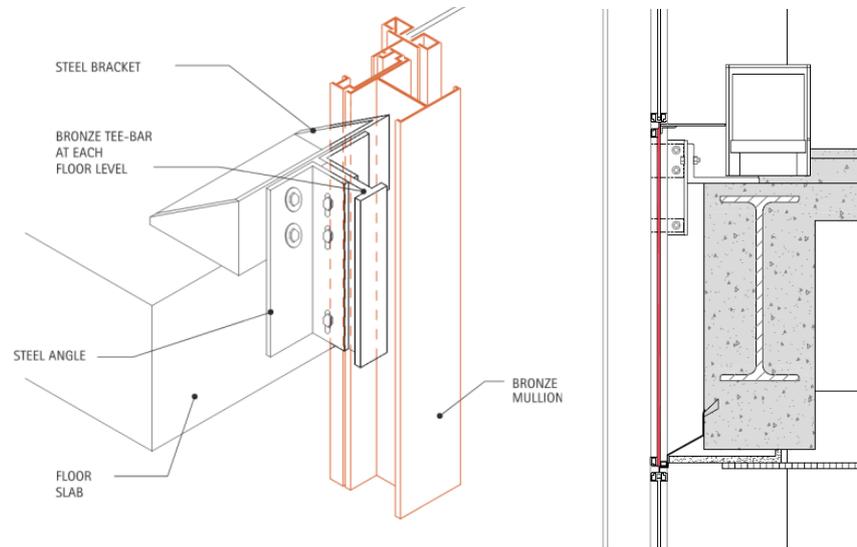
Izquierda: Vista del anclaje al forjado; derecha: sección vertical por el antepecho.
